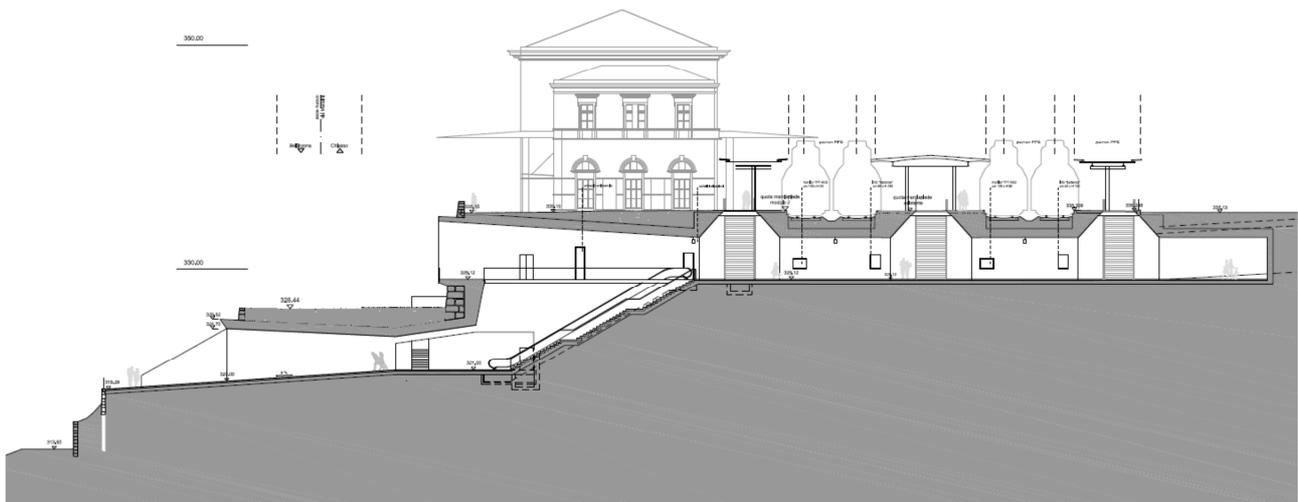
Sezione longitudinale del nuovo sottopasso.
